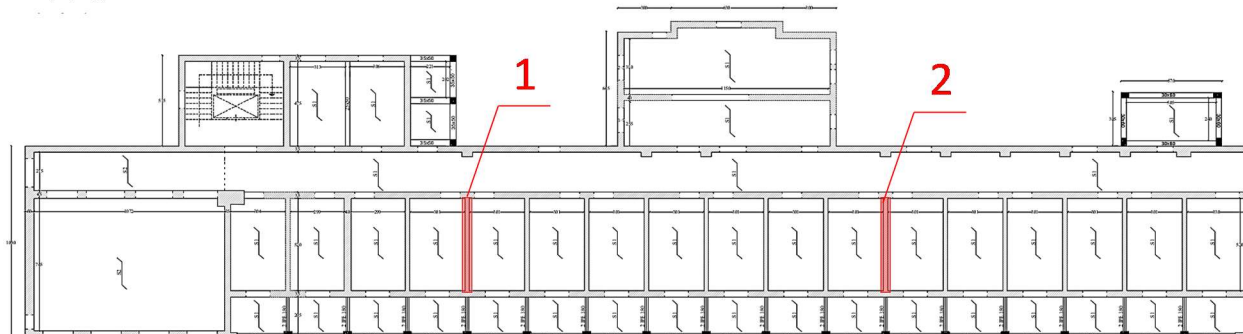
Muri oggetto di prova in rosso su planimetria edificio 2, piano primo.
